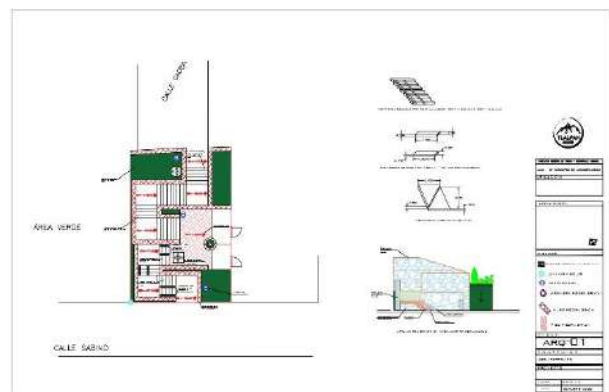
Plano de detalles. Foto de Luis Leonardo
